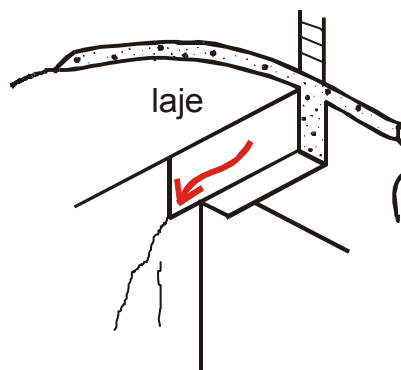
fissuras verticais e/ou inclinadas em apoio de viga sem coxim com excessiva sobrecarga (DUARTE, 1998)
